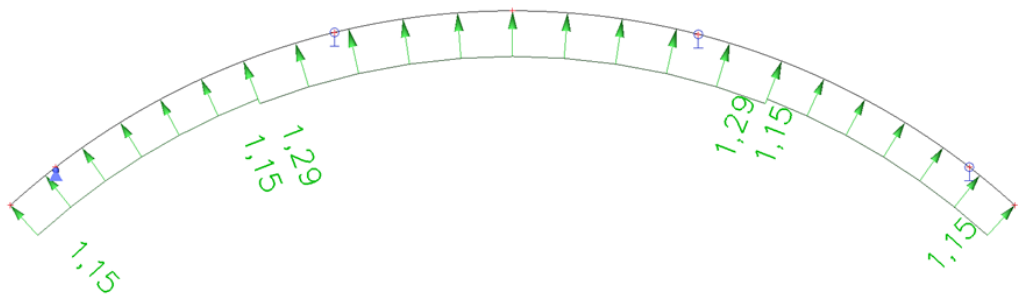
Zatížení střešní konstrukce - vítr příčný zprava
